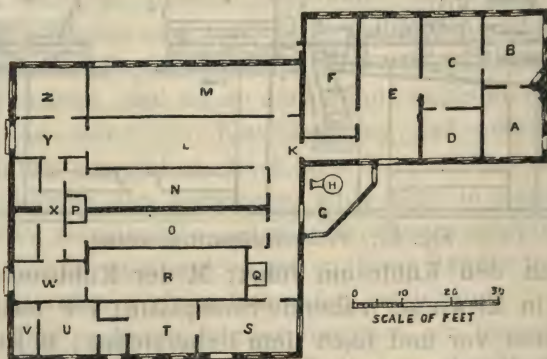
Grundriss der Fabrik von Marion.
